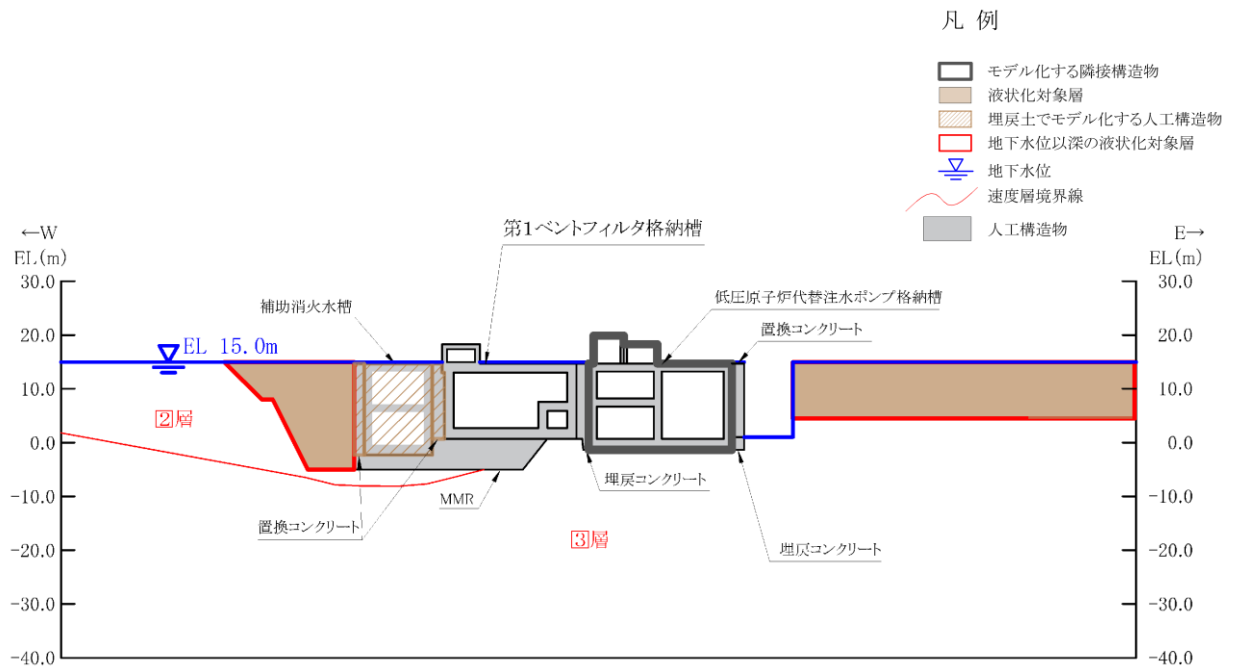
第 1 ベントフィルタ格納槽 評価対象断面図 (C-C 断面位置)
